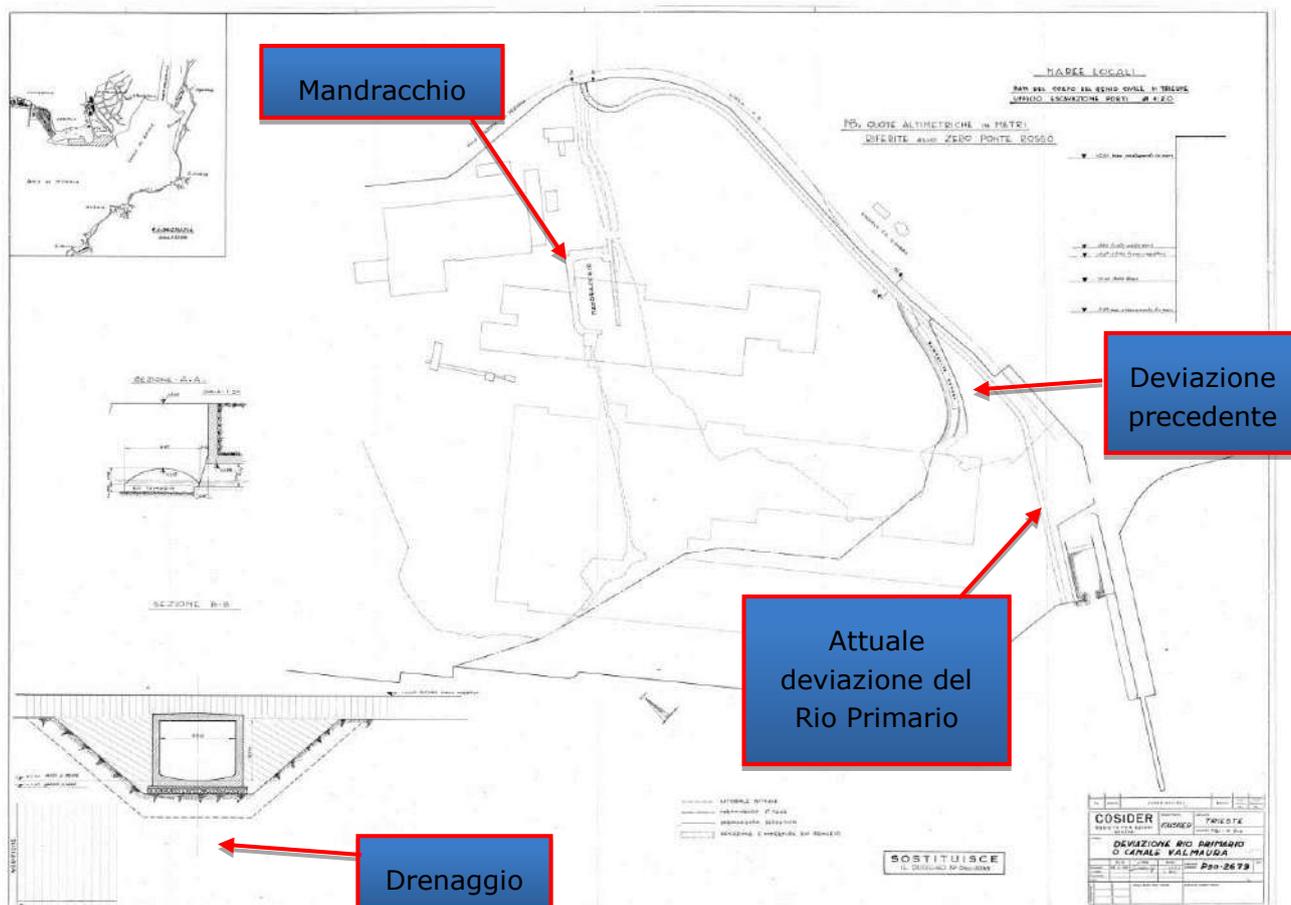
Planimetria del progetto di deviazione del Rio Primario del 1962
